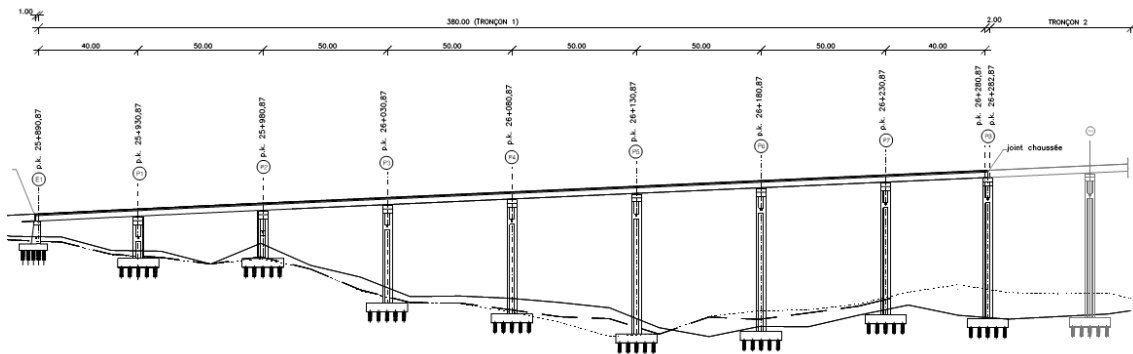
Primer tramo hiperestático. Subtramos 1+40,0 . 6x50,0 m y 1x40,0 m
